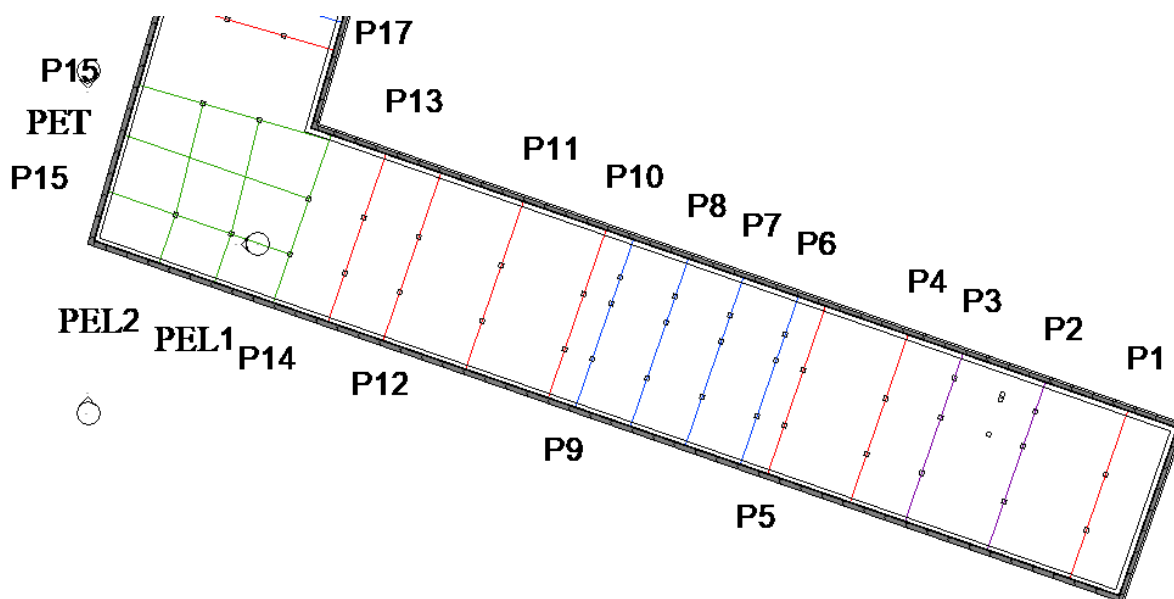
Fragmento del plano “Clasificación de Pórticos. Planta”. Fuente: Elaboración Propia
